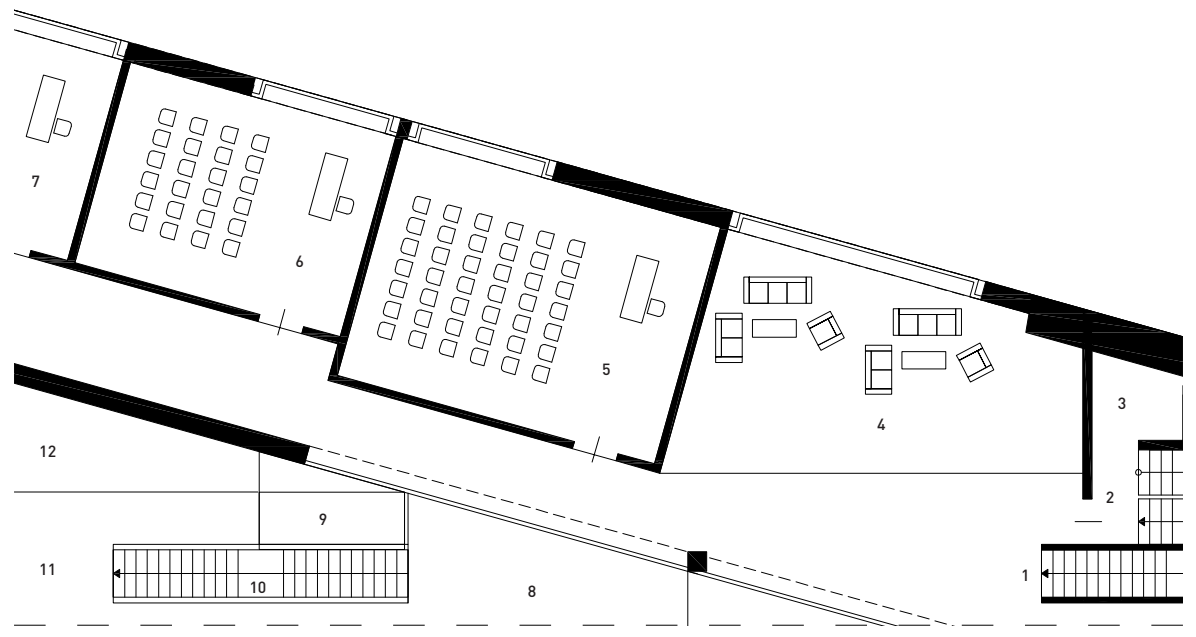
Grundriss Mehrzweckraum, Klassenzimmer\_1, Klassenzimmer\_2 M1:200
